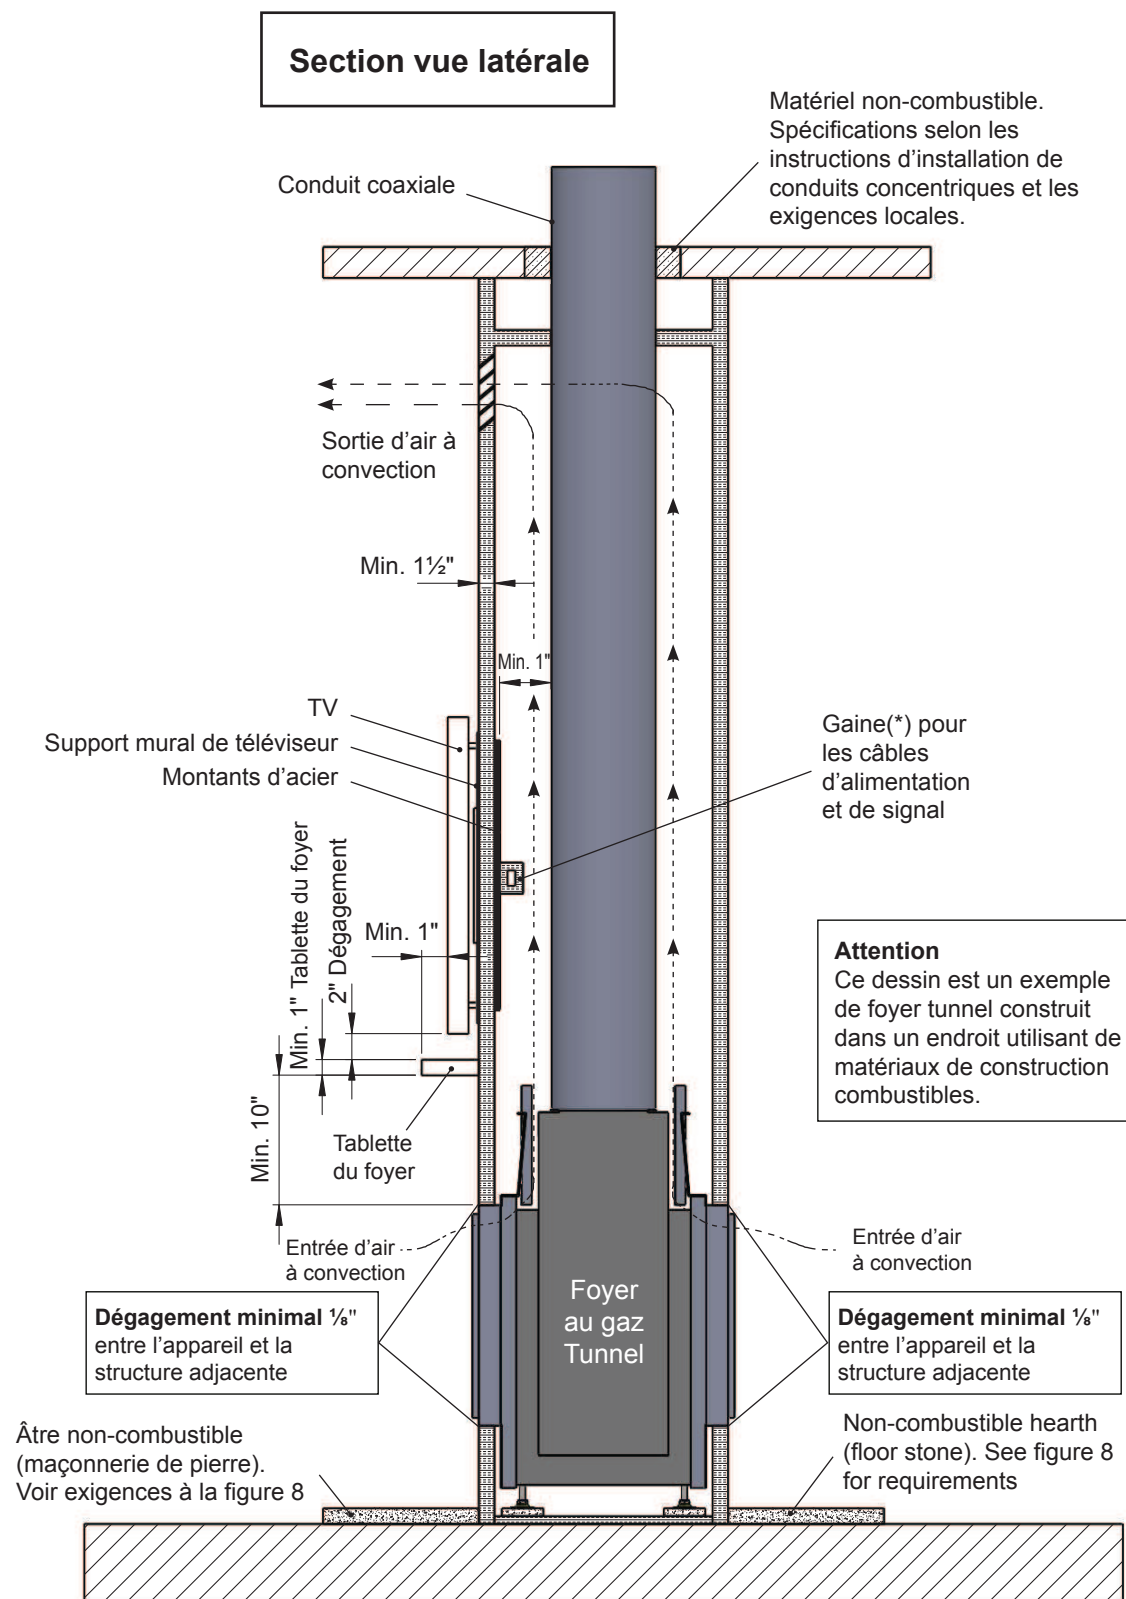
Installation du téléviseur au-dessus de la tablette de cheminée (Foyer plat Tunnel) (Installation en surface) - Section - vue latérale
